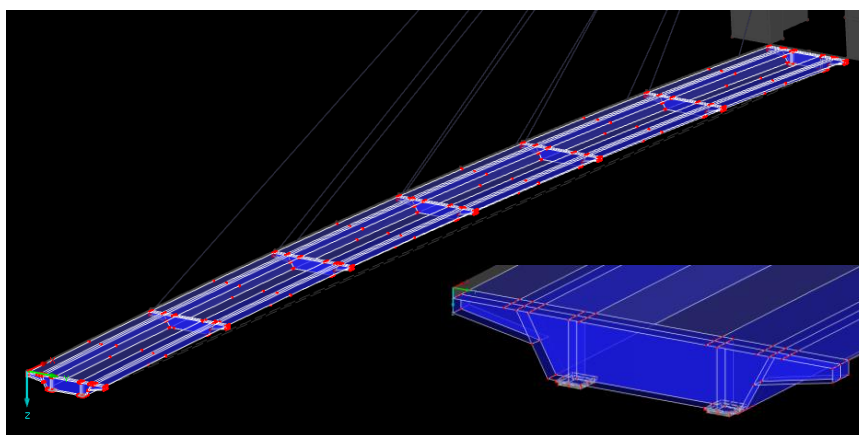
CAJÓN METÁLICO DE ACERO S-355
